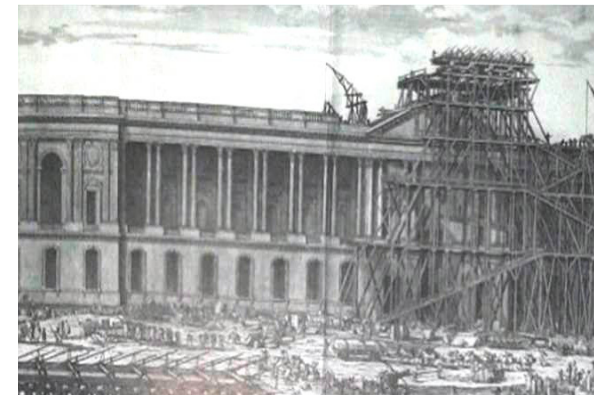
Columnata del Louvre, Paris, 1670, construida por Claude Perrault. (De Cabinet du Roi: Chateaux du Louvre, 1727; Cortesía de la biblioteca del RIBA, Londres.)
